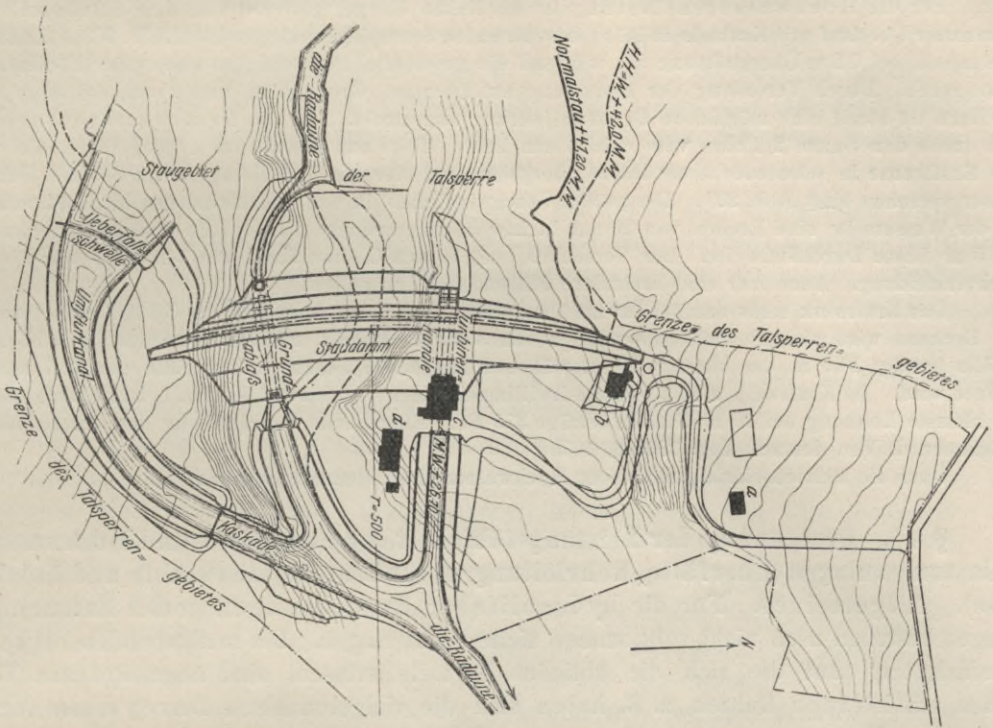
Lageplan des Staudammes an der Radaune bei Danzig. 1:4000.
